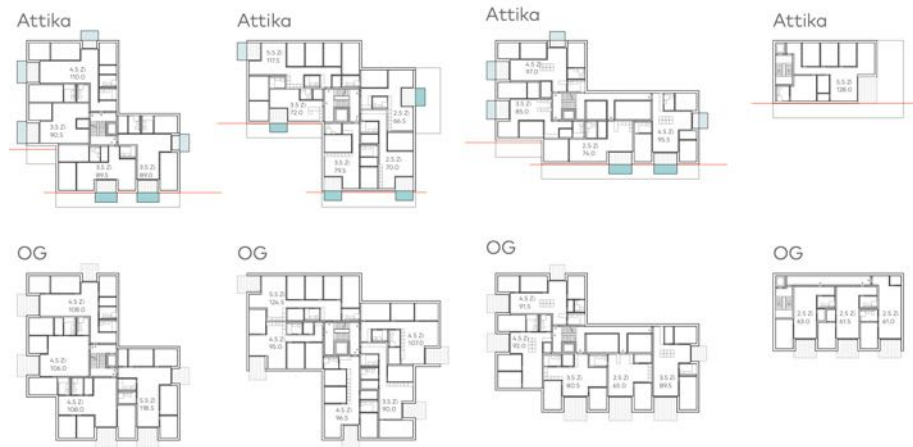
Attikageschoss im Grundriss (oben) mit den vorspringenden Attikaterassen mit Brüstung in der 2. Bauungsreihe. Darunterliegendes Vollgeschoss (OG) im Grundriss (unten). Die rote Linie markiert den Rücksprung des Attikageschosses von 2.5 m.
